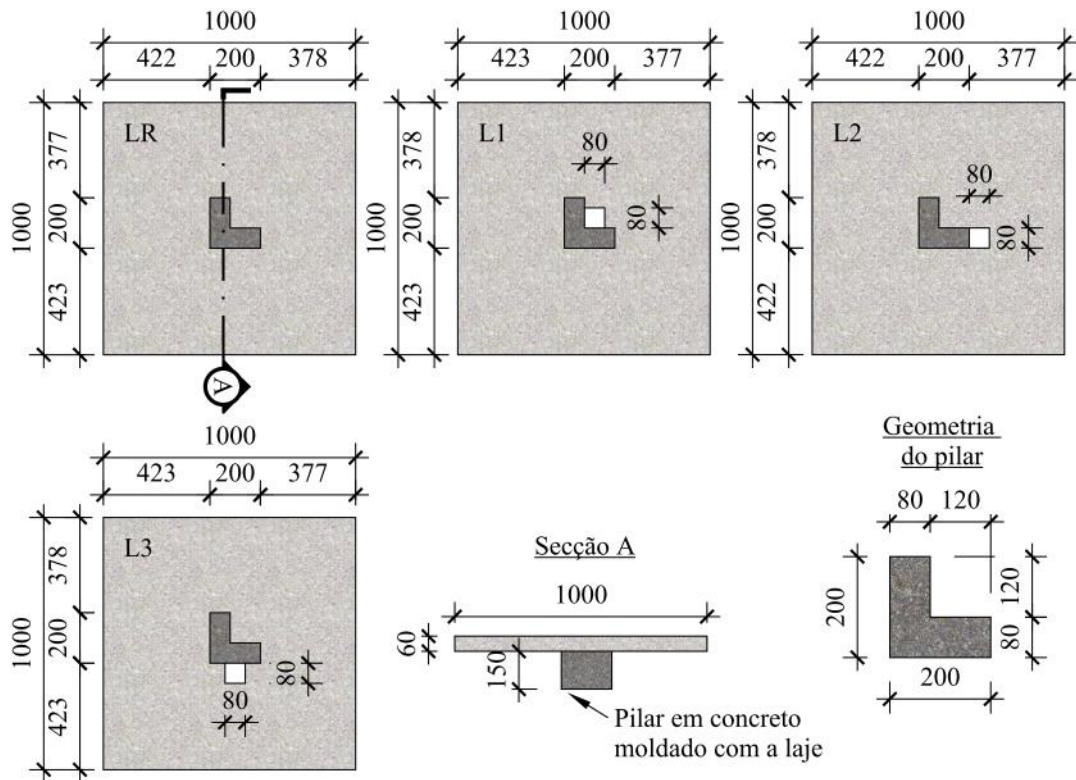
Geometria das lajes de PINTO *et al.* (2014)
